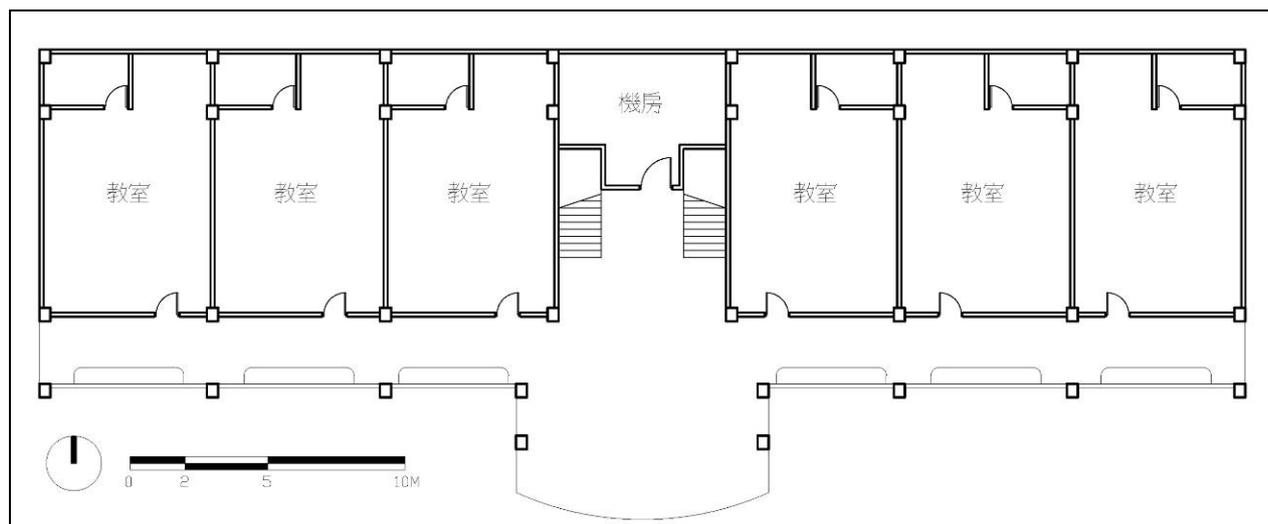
澎湖縣小門國小舊校舍一樓平面圖
